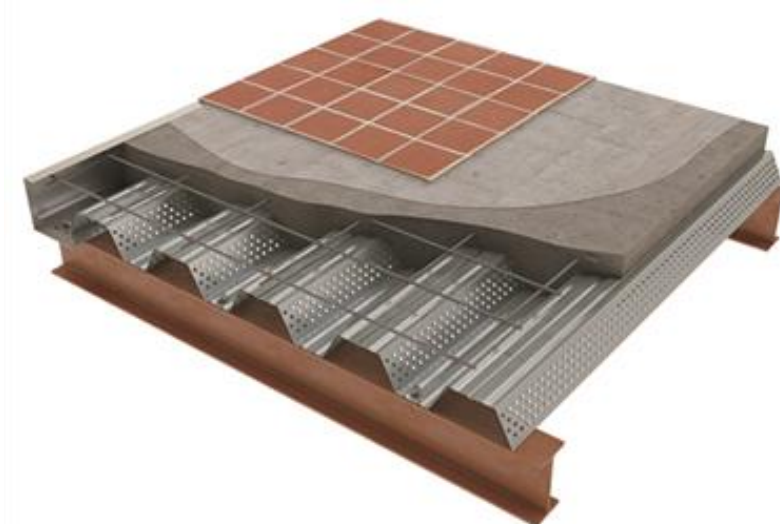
Perspetiva de pavimento de laje mista de aço-betão
